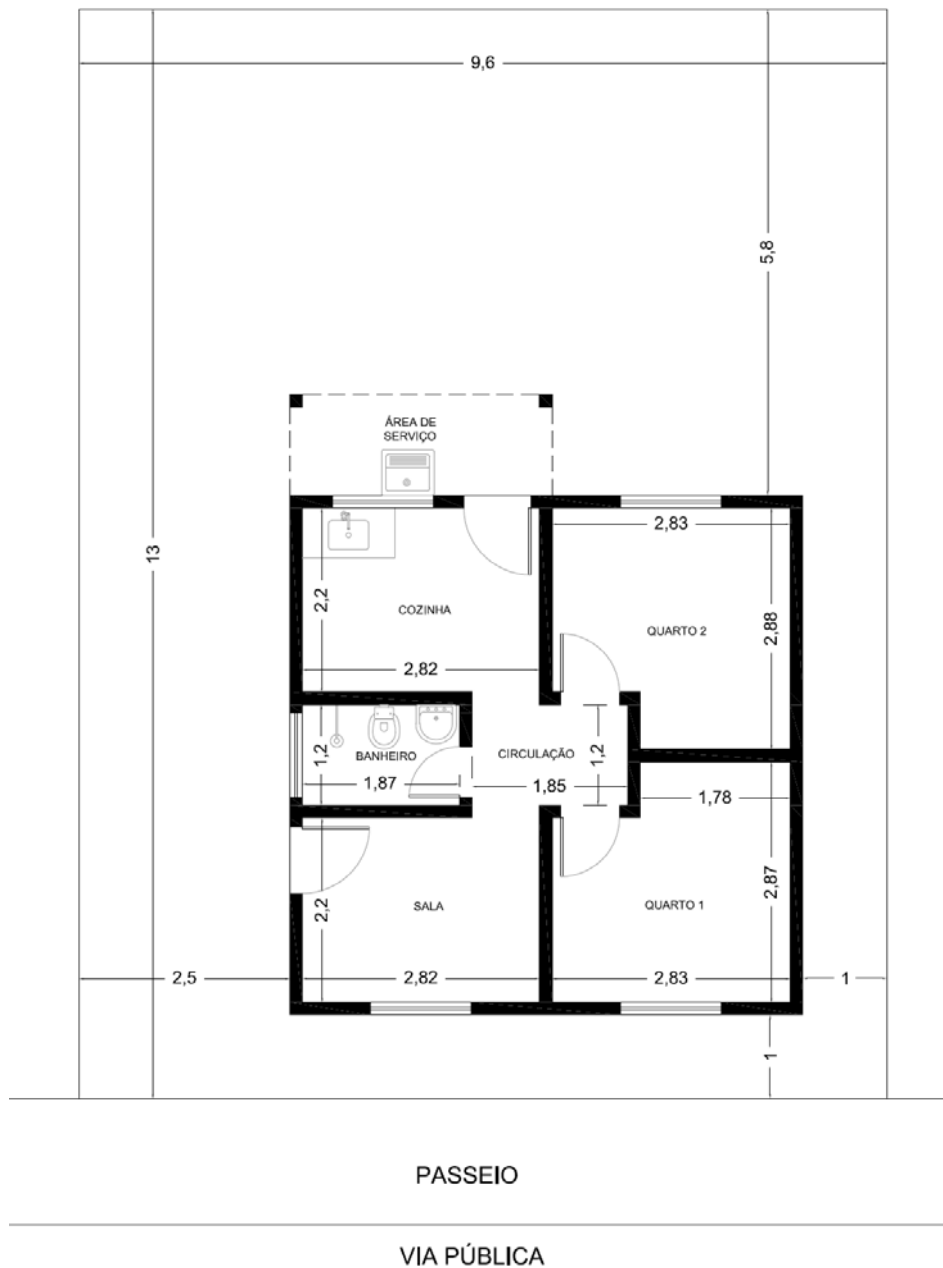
Planta baixa da unidade habitacional original e a sua implantação no terreno
